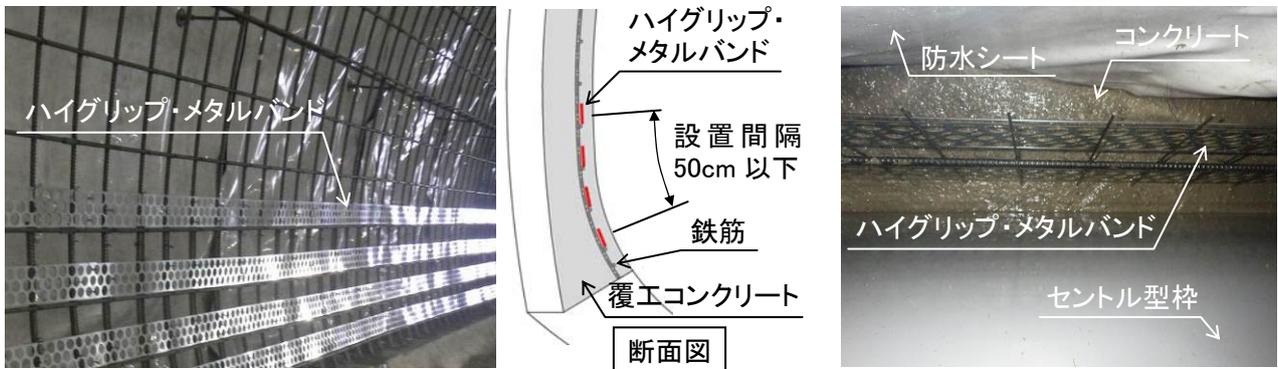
ハイグリップ・メタルバンドの施工例（上高地トンネル）
